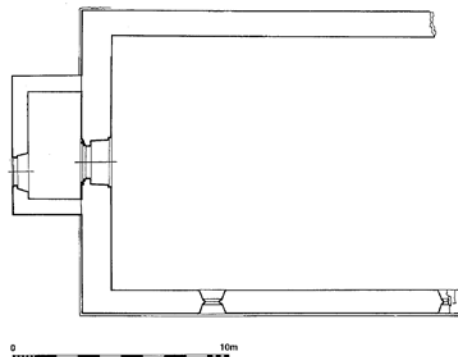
Grundriss der Klosterkirche von Krasíkov. Vermessung und Zeichnung Dalibor Prix.
